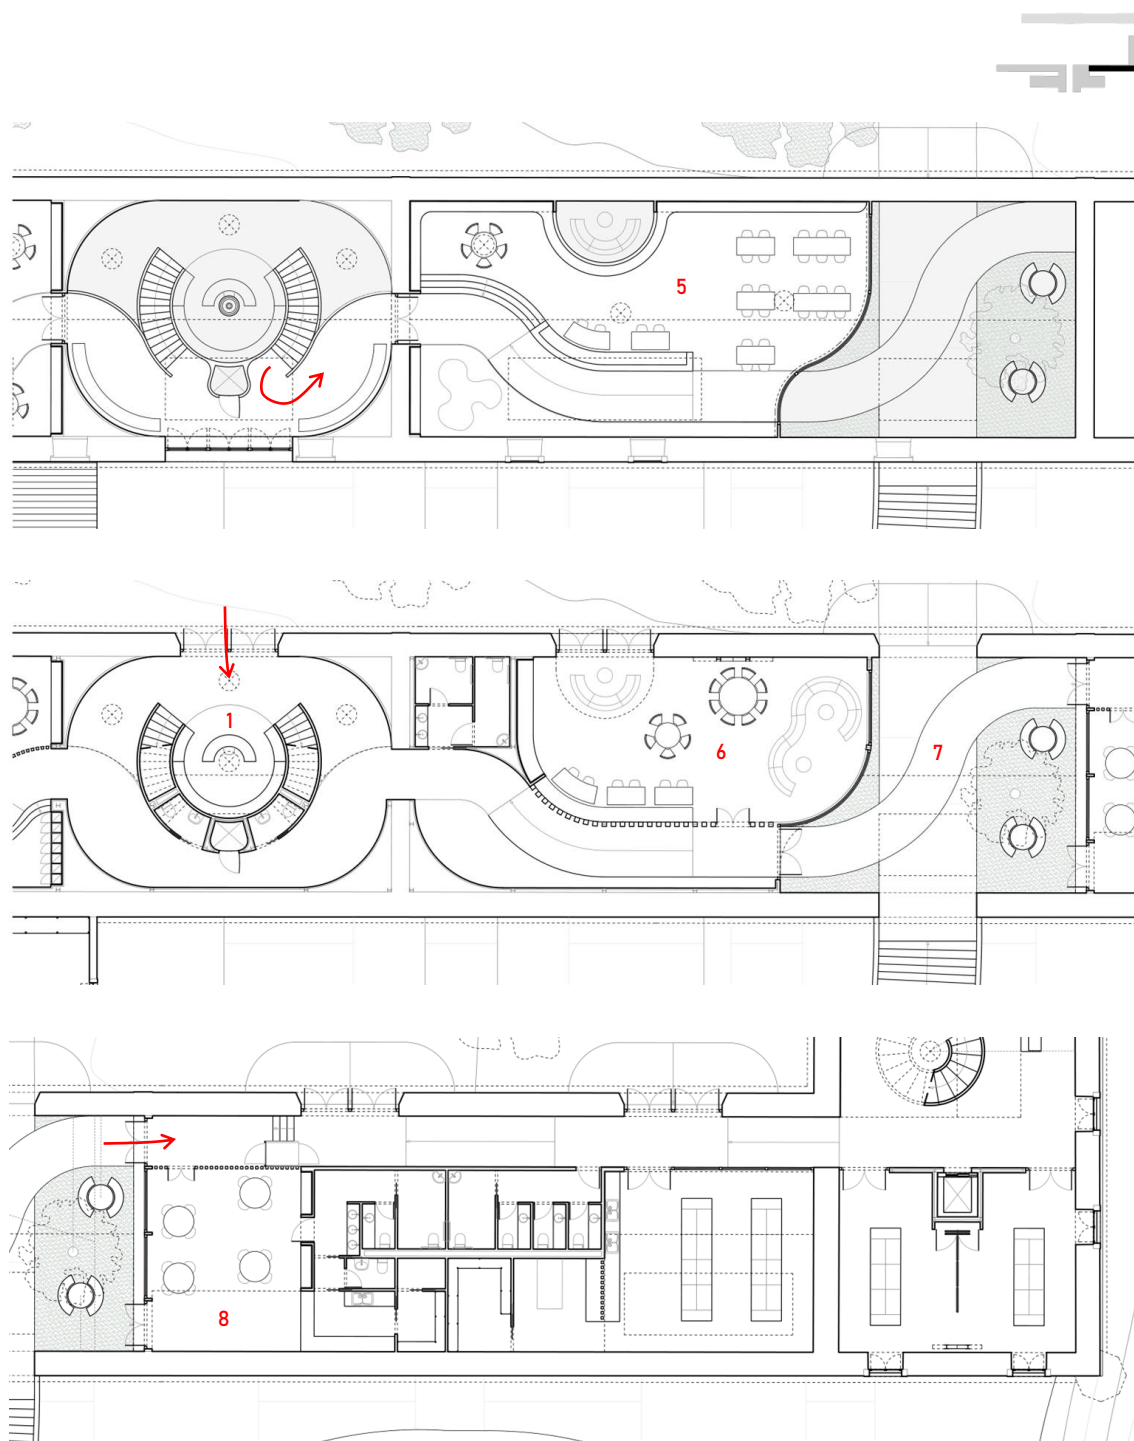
| Planta da cafetaria e dos *ateliers* sul e plantas do piso 0 e do piso 1 do centro intergeracional (de baixo para cima, respectivamente) (sem escala).
